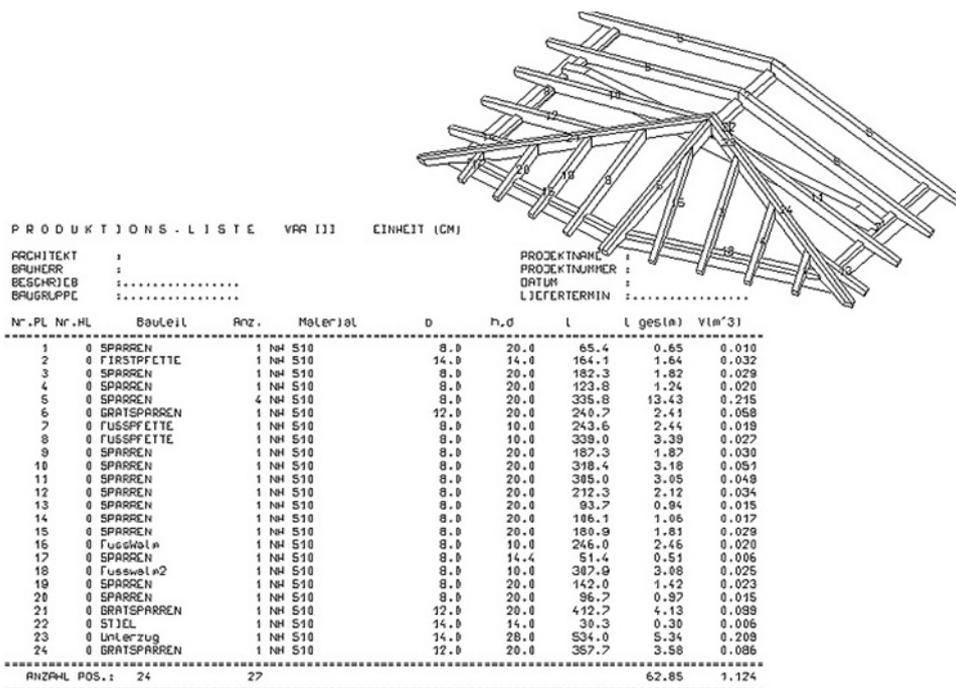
Holzbauplan mit Produktionsliste²⁶
